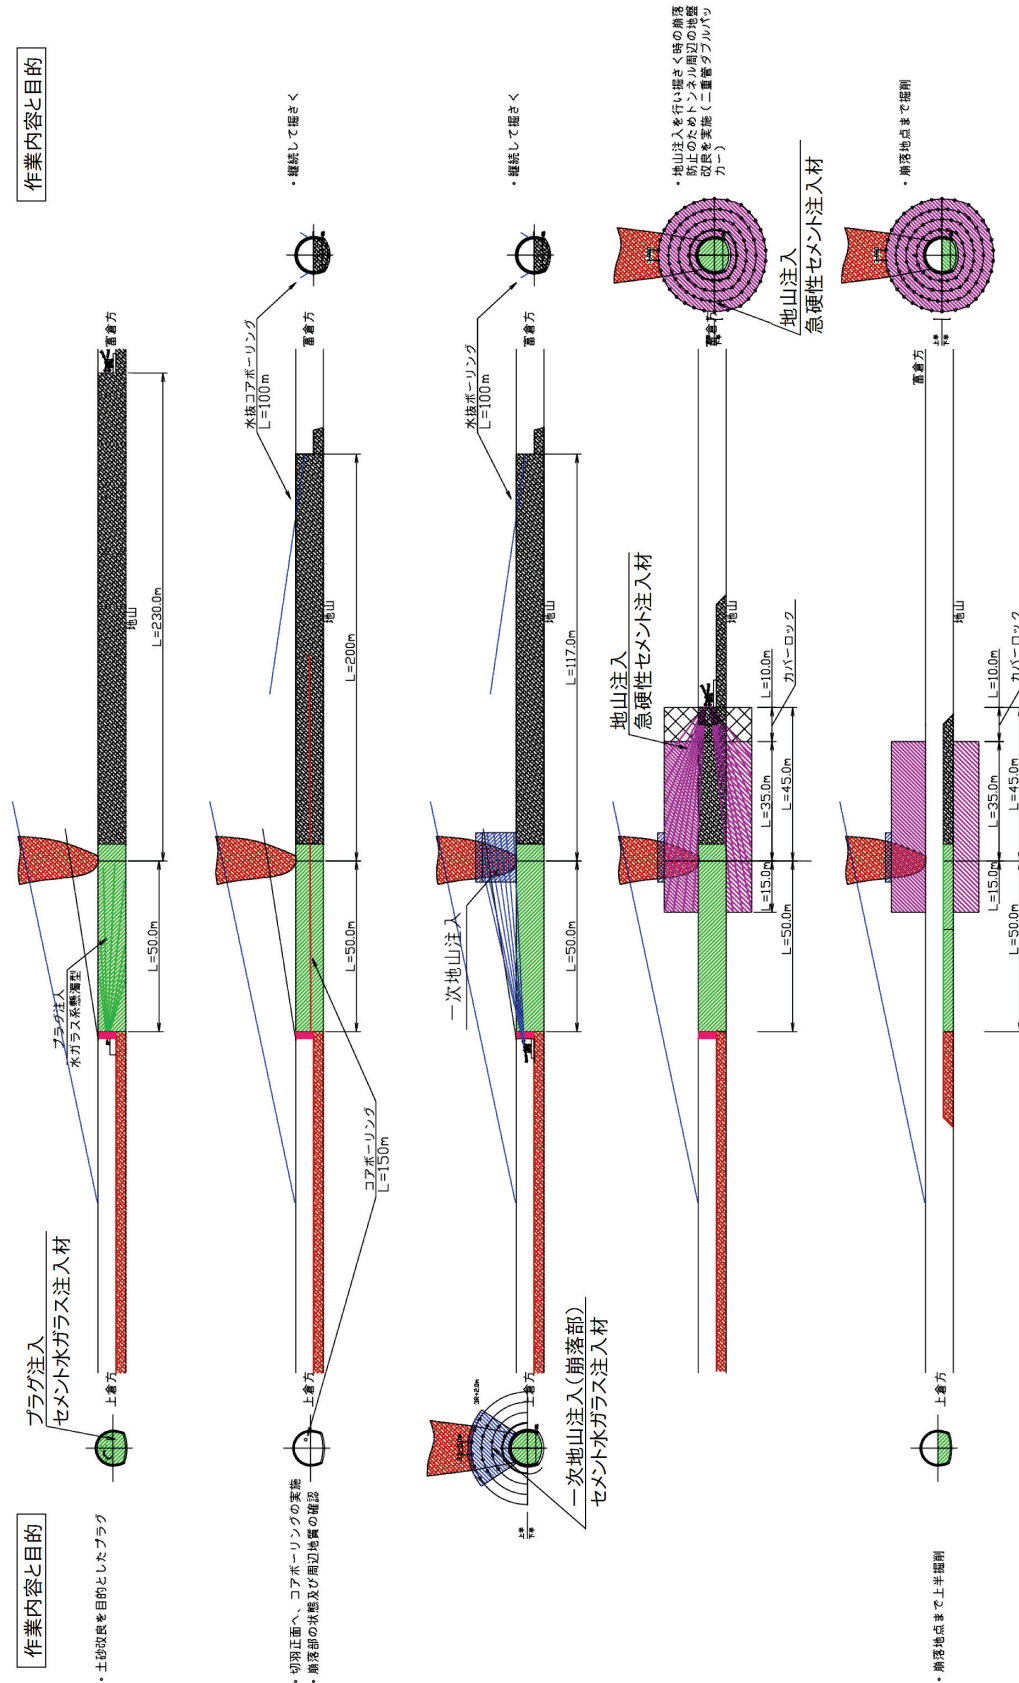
崩落部の施工順序⁹⁾を加筆修正
